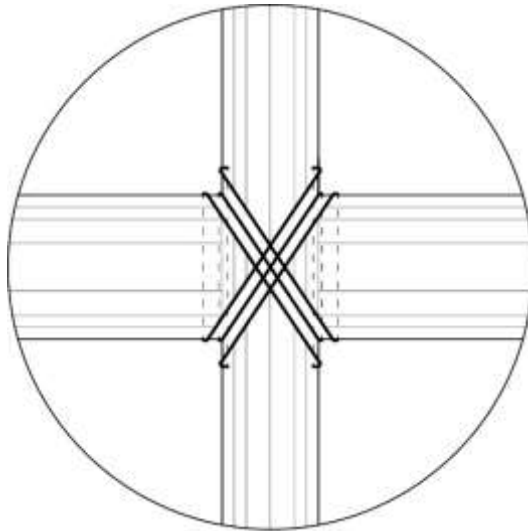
Detalle cimentación columna - Achuar
